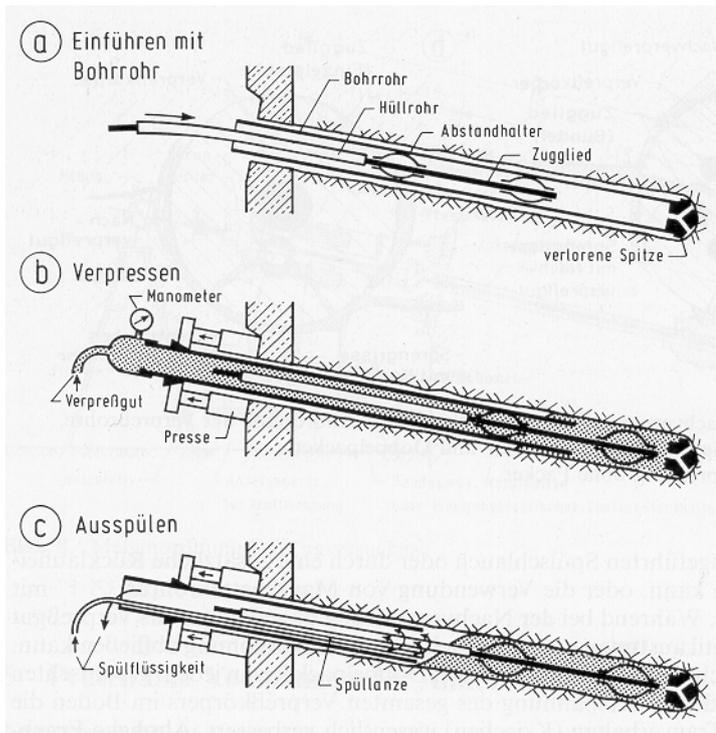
Ankereinbau: Einführen, Verpressen, Ausspülen [11]
